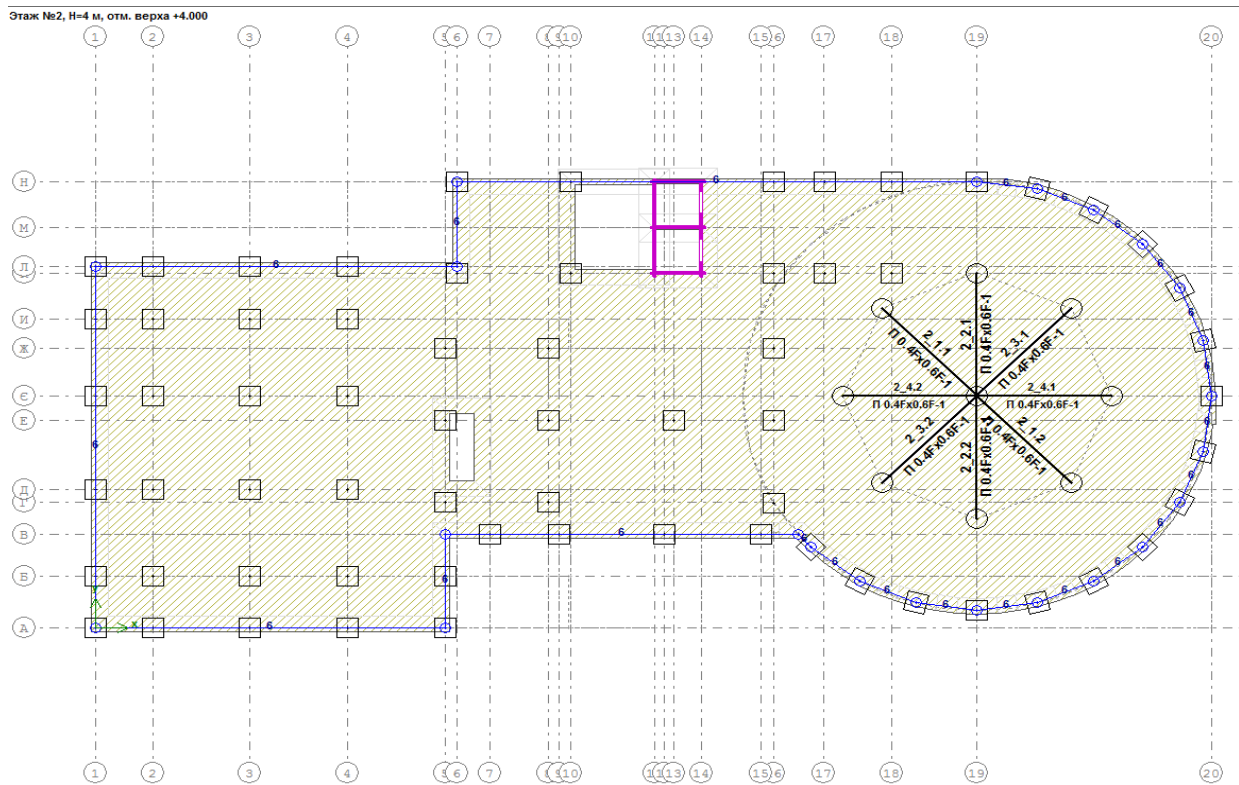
Розрахункова схема типового поверху будівлі бібліотеки
